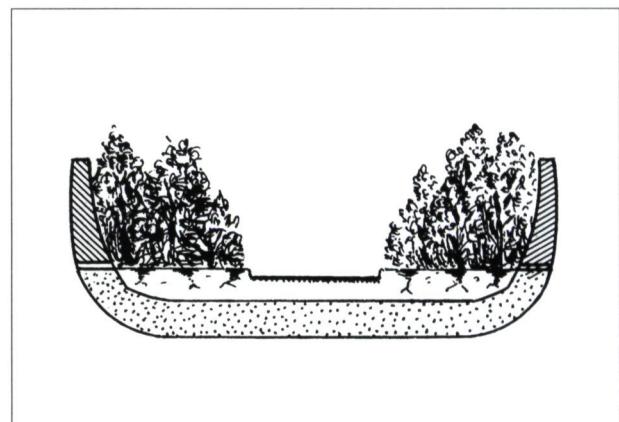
SURELEVATION DES PLANTATIONS.
